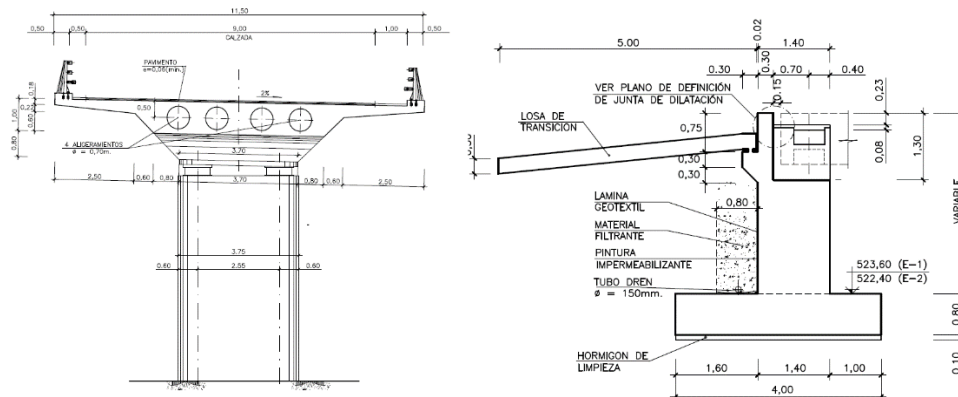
Alzado de las pilas y estribos de las estructuras 1 y 2
